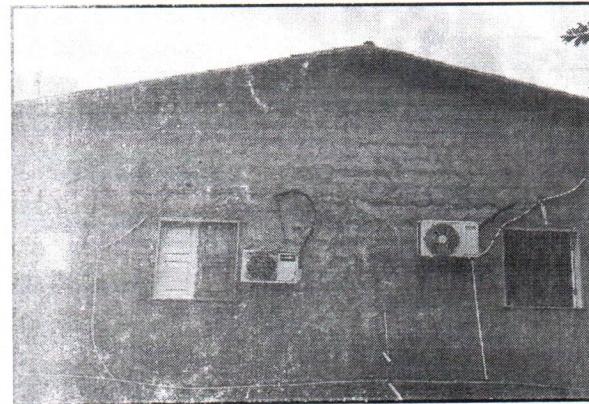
Vista Lateral do Imóvel, com destaque as esquadrias de madeira
